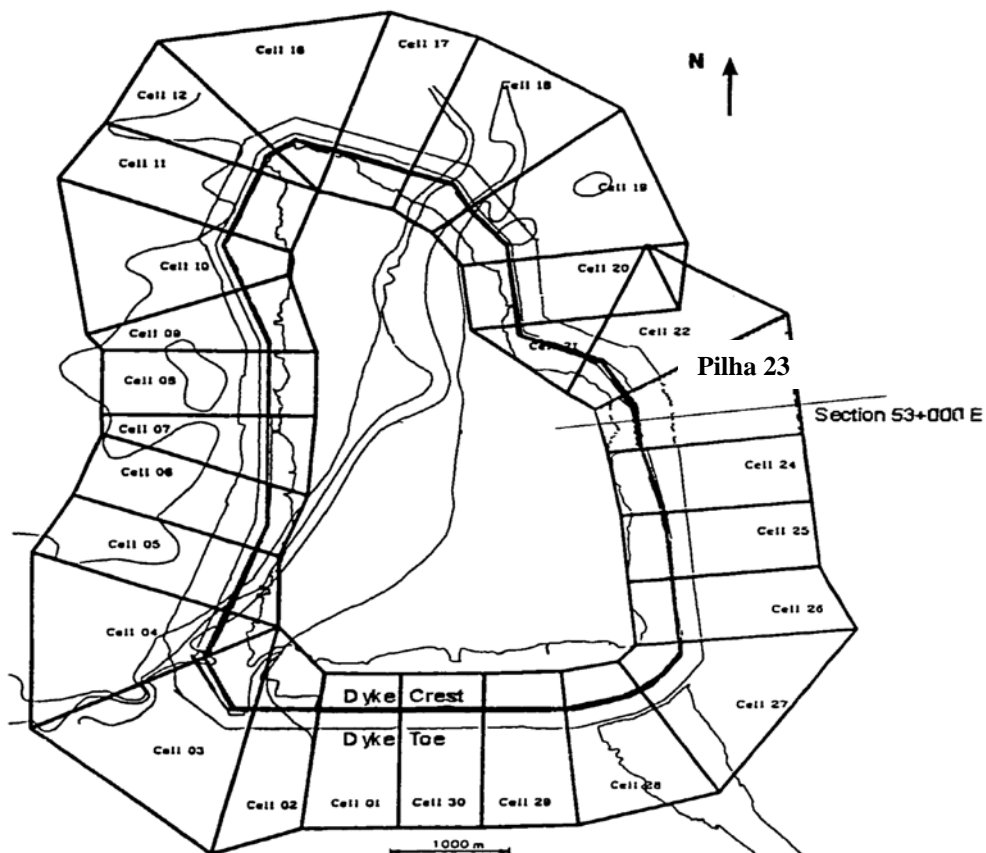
Vista em planta das pilhas e lagoa de rejeitos.
